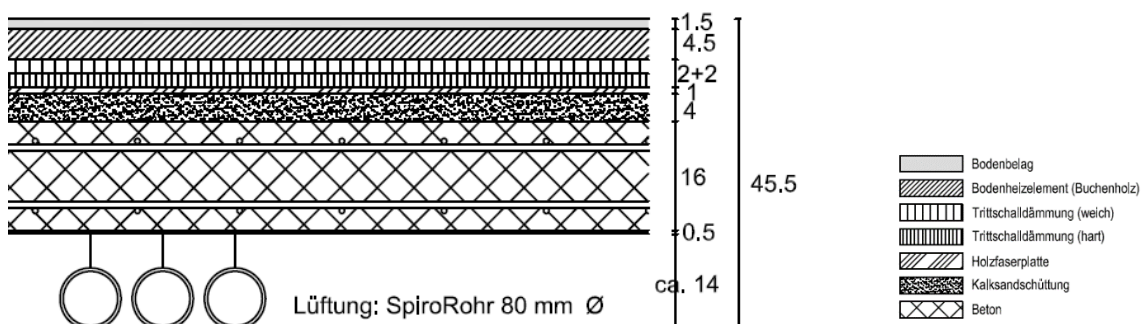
Querschnitt Zusatzvariante 4c «Leitungen sichtbar geführt, Betondecke nach Statik dimensioniert (16 cm)» mit Unterlagsbodenelement aus Holz im Trockenaufbau gemäss Tabelle 13
